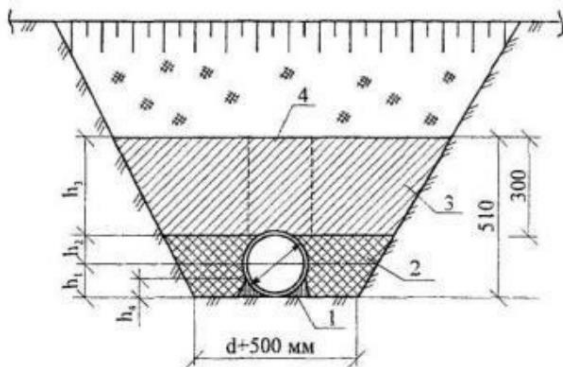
Схема уплотнения грунта вокруг трубопровода при засыпке траншеи:
